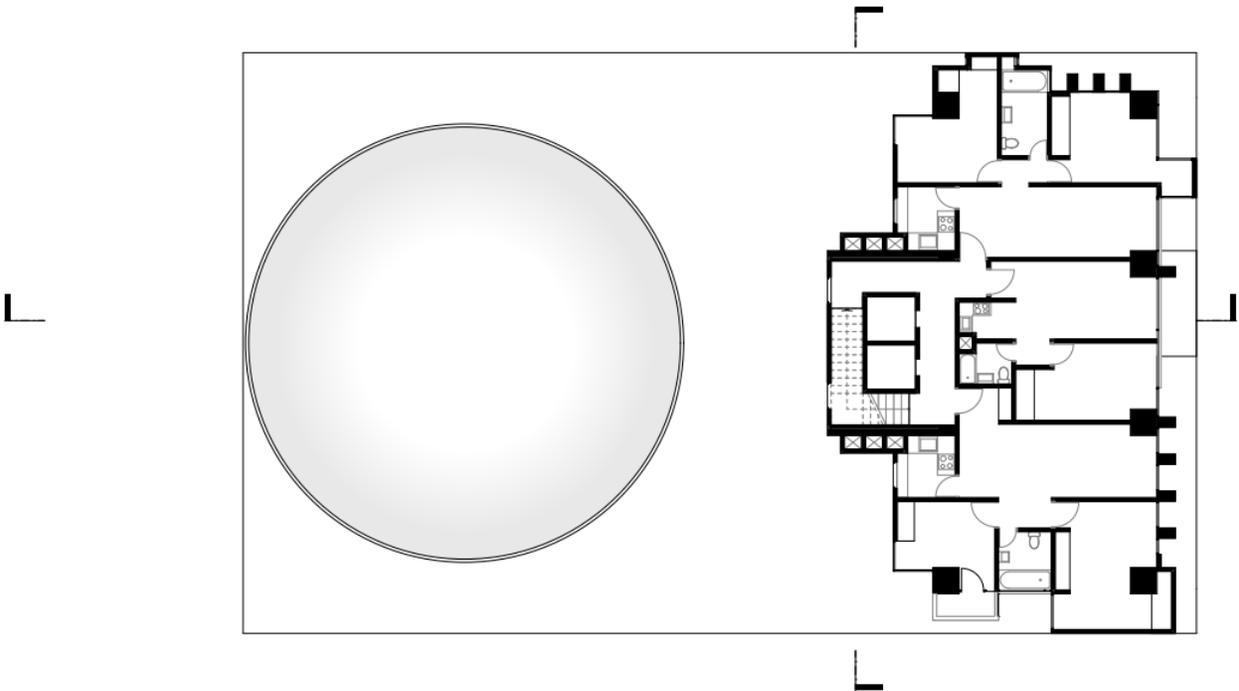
Planta alta planificada N+36.50. Fuente: Tesistas.
